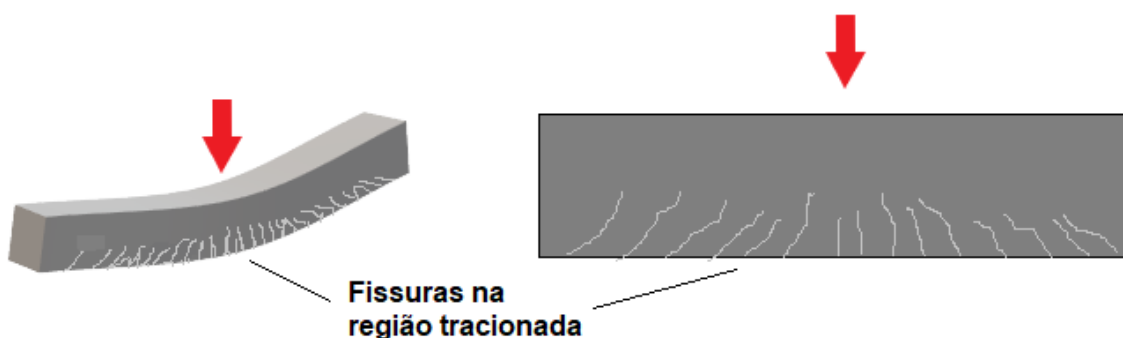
Fissuras formadas na região tracionada de uma viga submetida à flexão.
